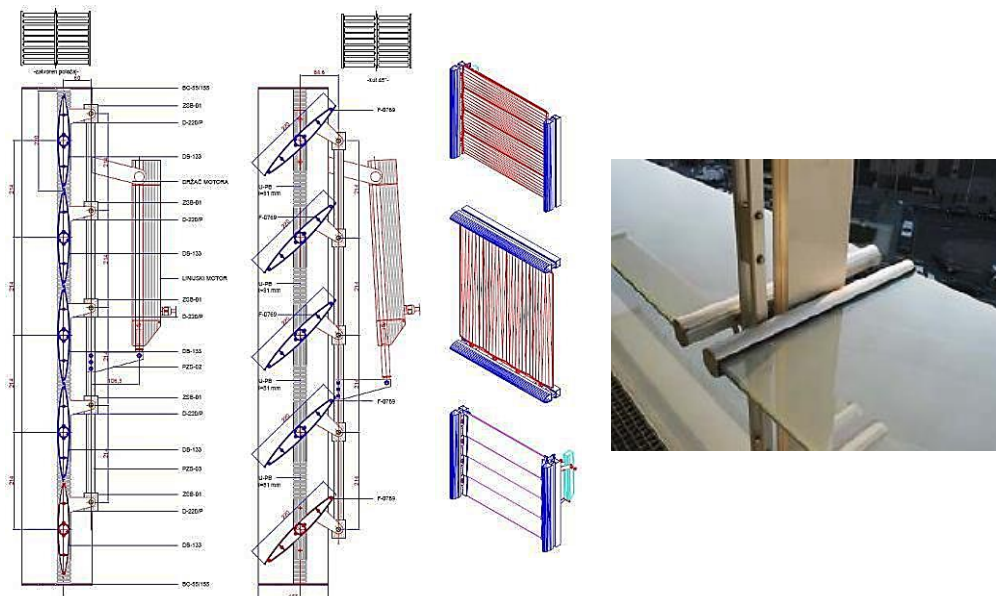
Fachada ventilada con hoja exterior formada por lamas
